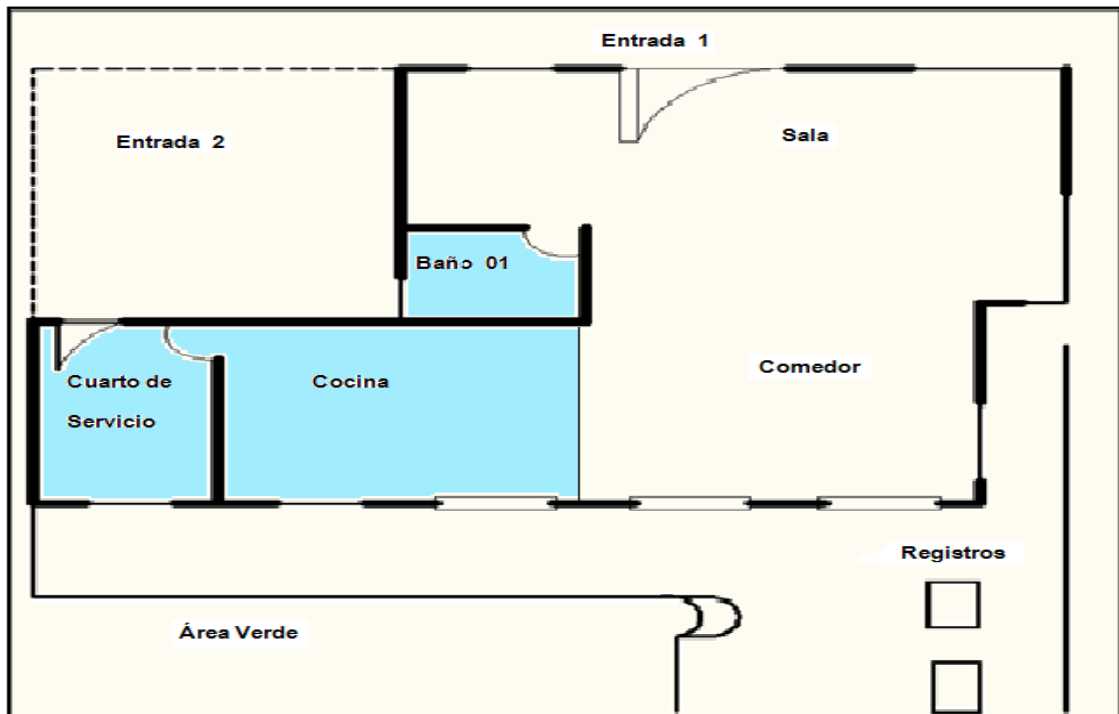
Distribución de servicios en planta baja de la casa en estudio
